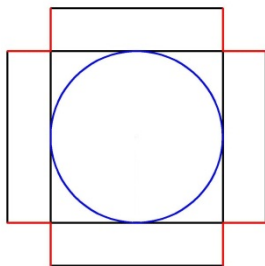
Esquema estrutural da Ermida São João Baptista da Carrasqueira.
